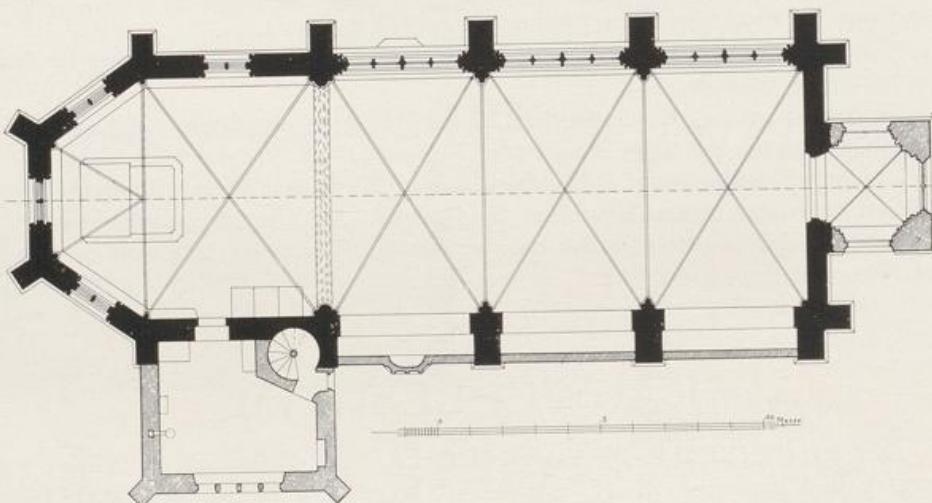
Frauwüllesheim. Grundriss der kath. Pfarrkirche nach der Herstellung.
